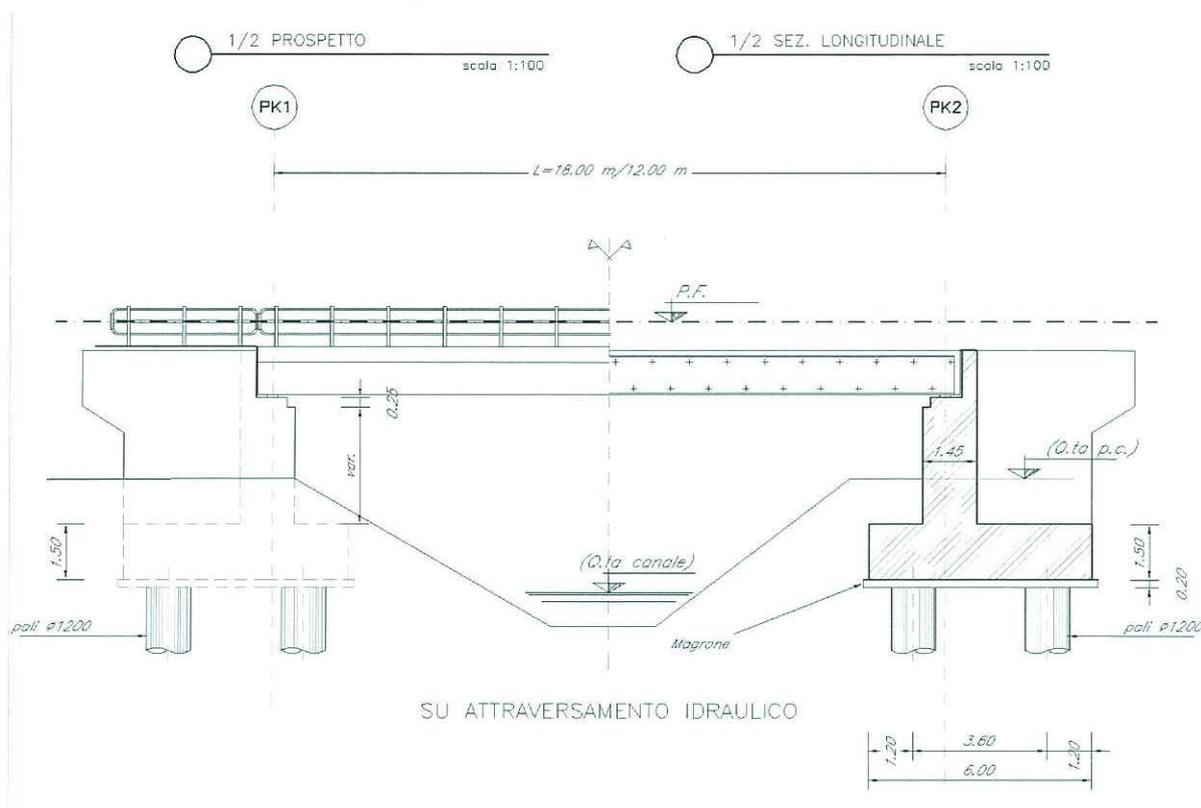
Prospetto/Sezione longitudinale in corrispondenza di attraversamento idraulico.
